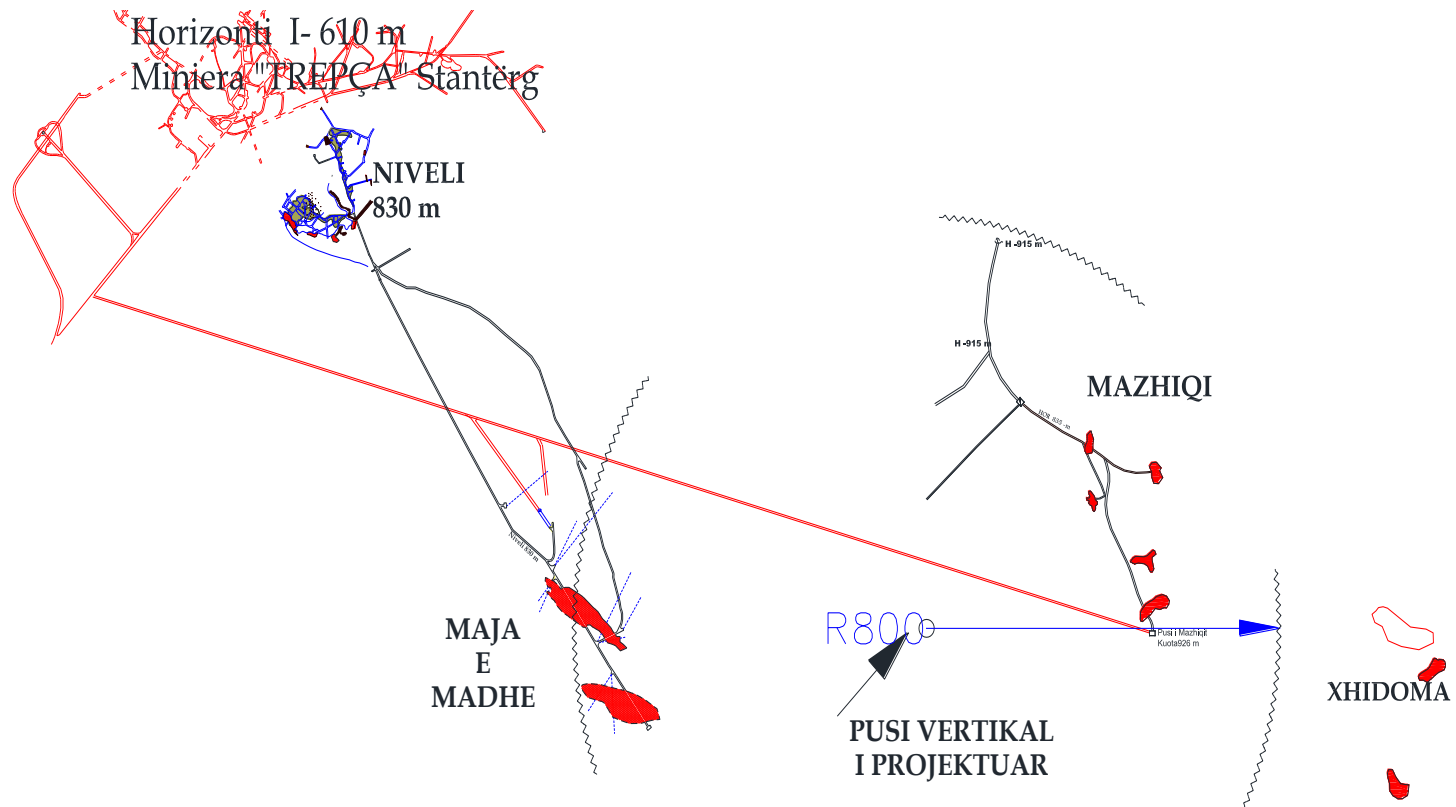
Paraqitja në plan pozicionimit të pusit vertikal
